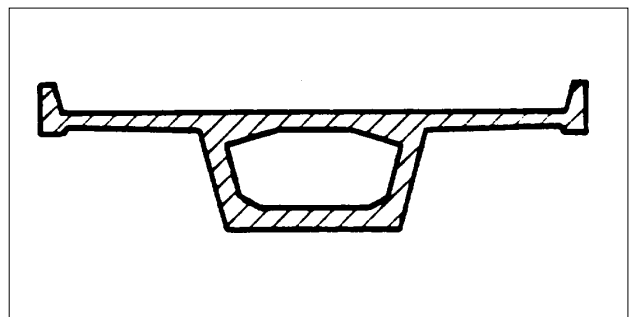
Typische Spannbetonbrücke für den Strassen- und Bahnverkehr:
